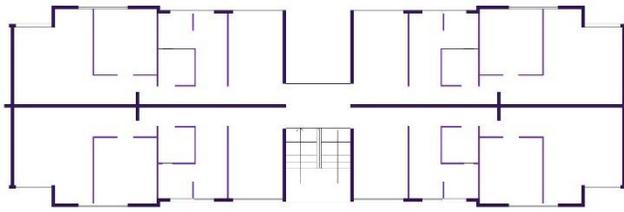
Estructura tipología nº1. Fuente: Elaboración propia.
